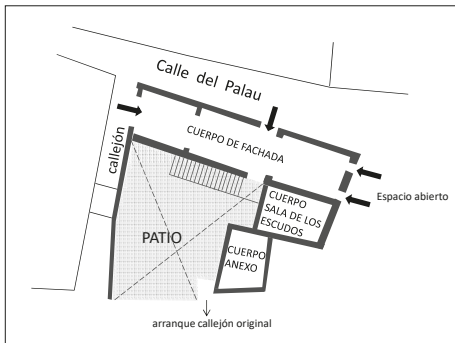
Plano de planta baja de la Casa de Pere de Vila-rasa. Ca. 1320.
